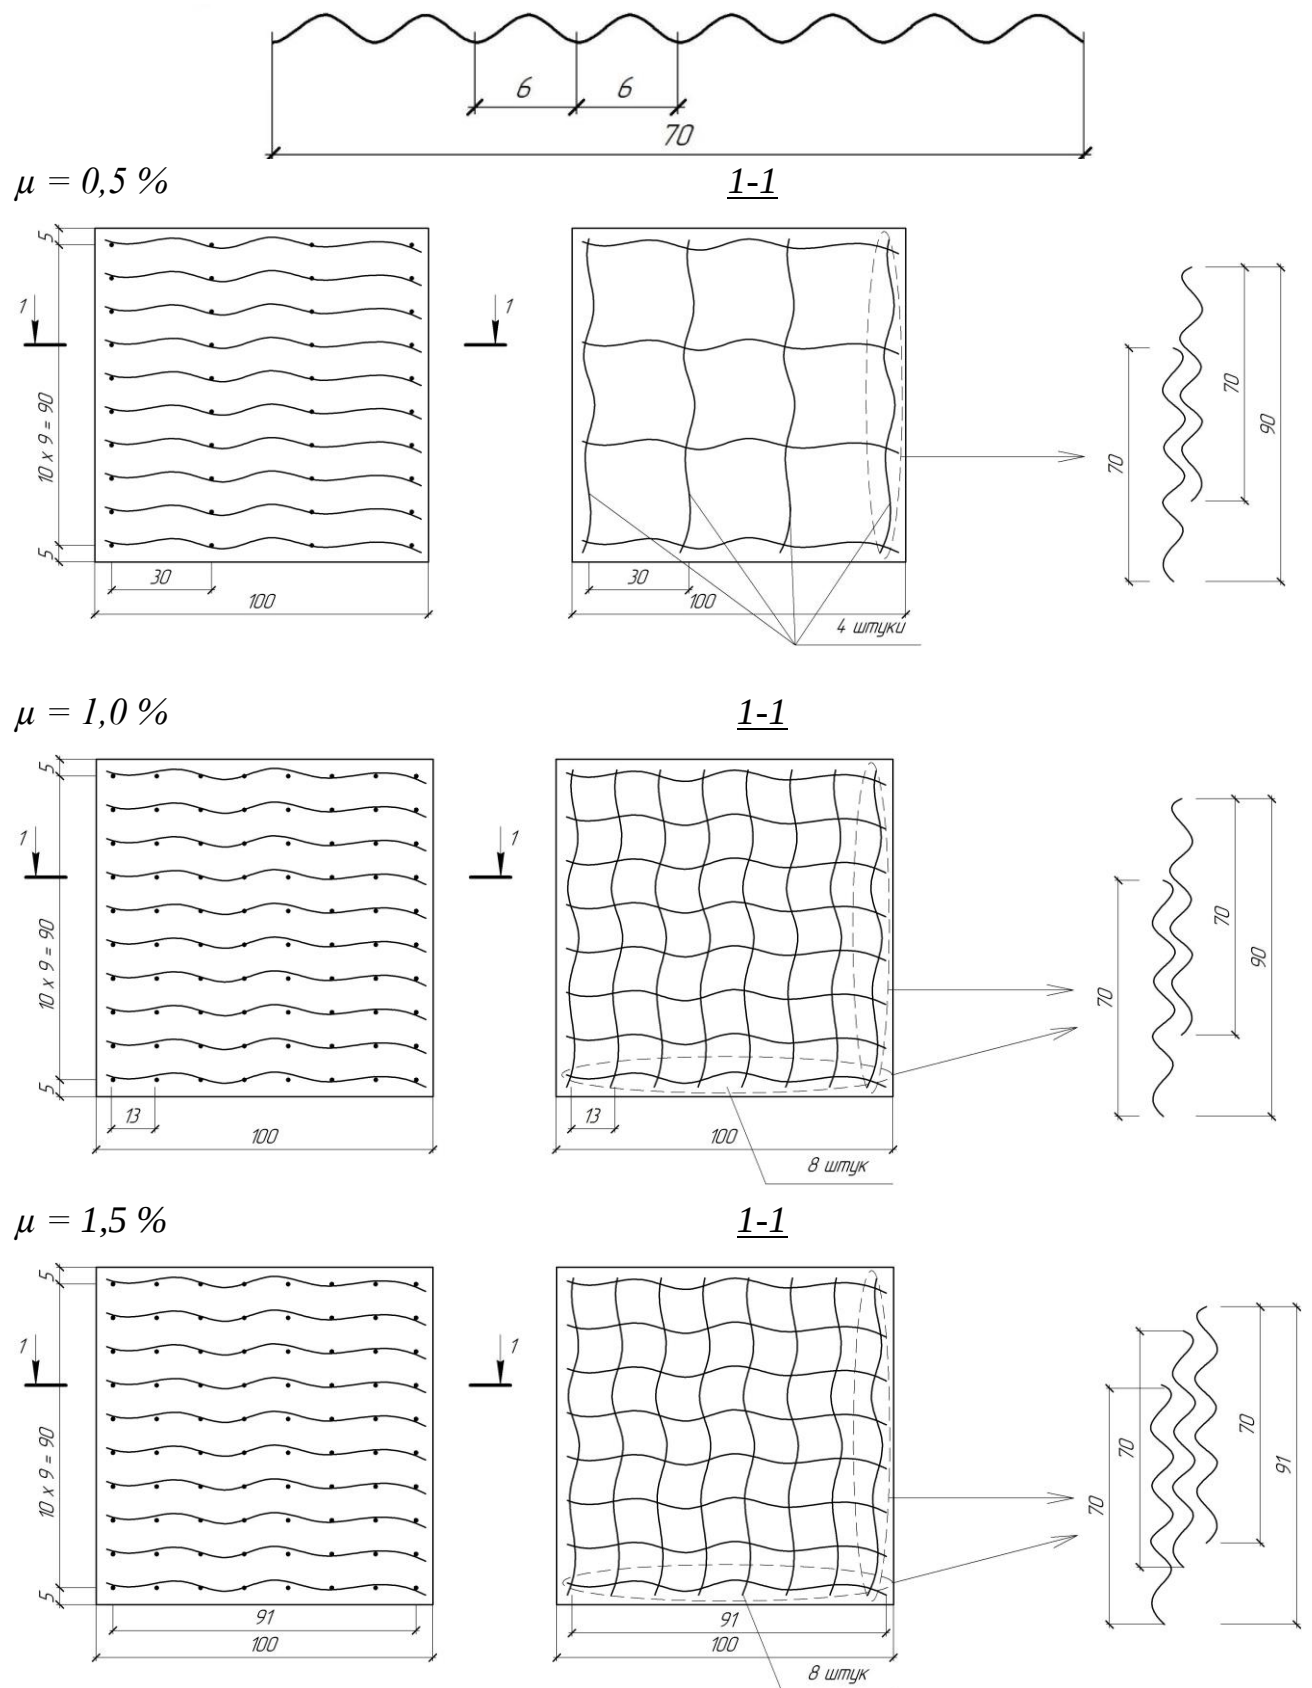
Армирование сжатых элементов сетками из проволоки (волнистой)
